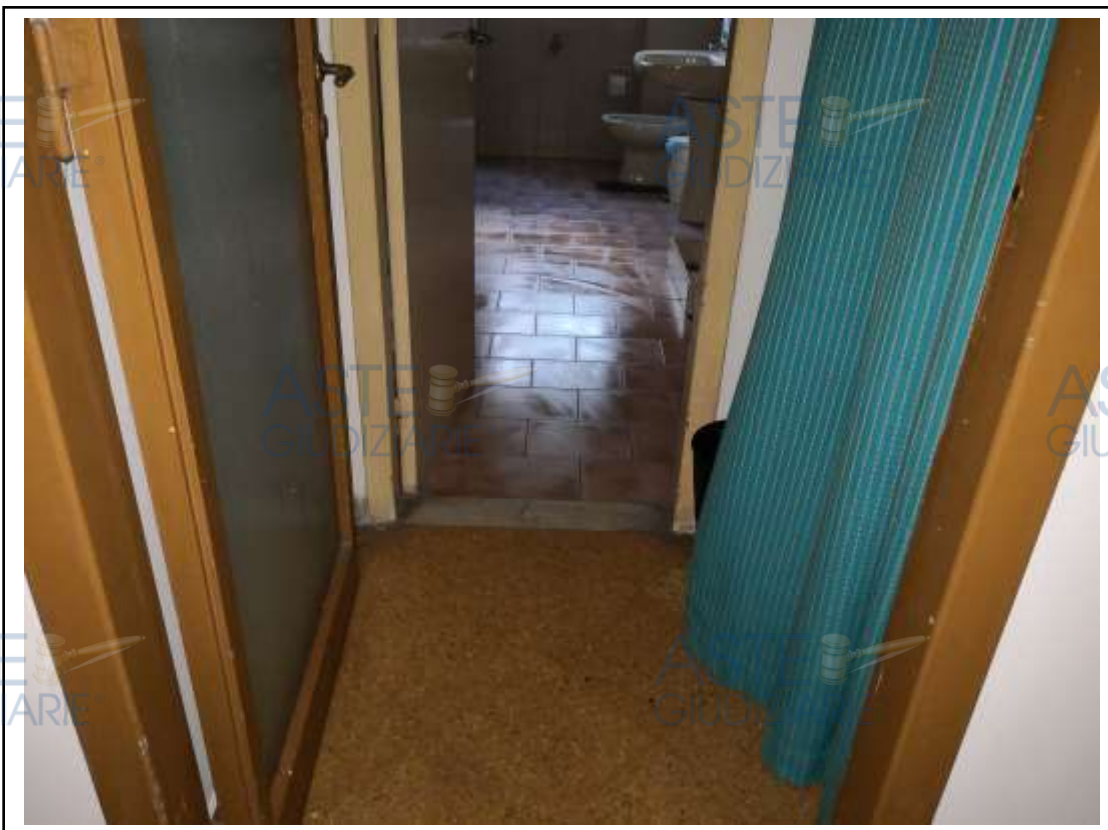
Ufficio sito in Palermo, Piazza G. Mameli n. 1, piano rialzato. W.c.d.
